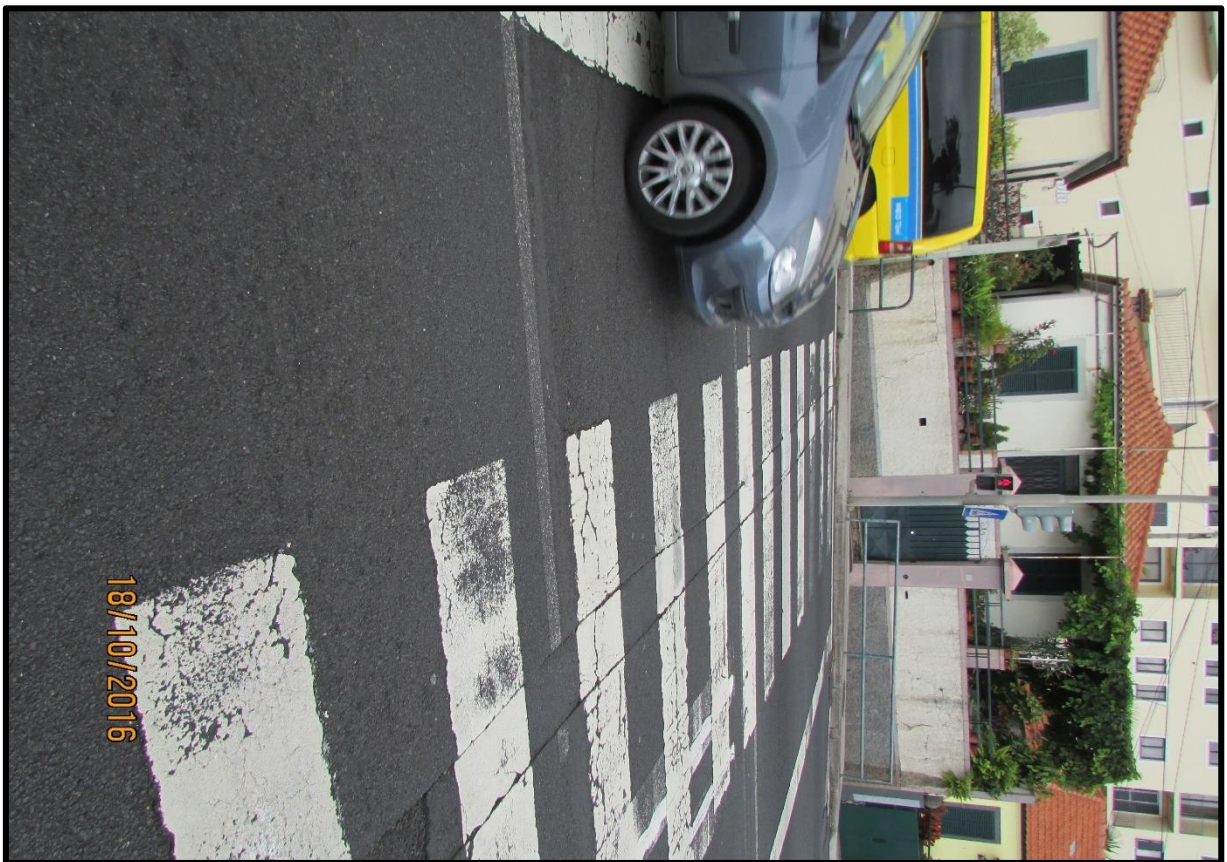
Fissuras transversais – Grau de severidade médio (pk \approx 0+60)
